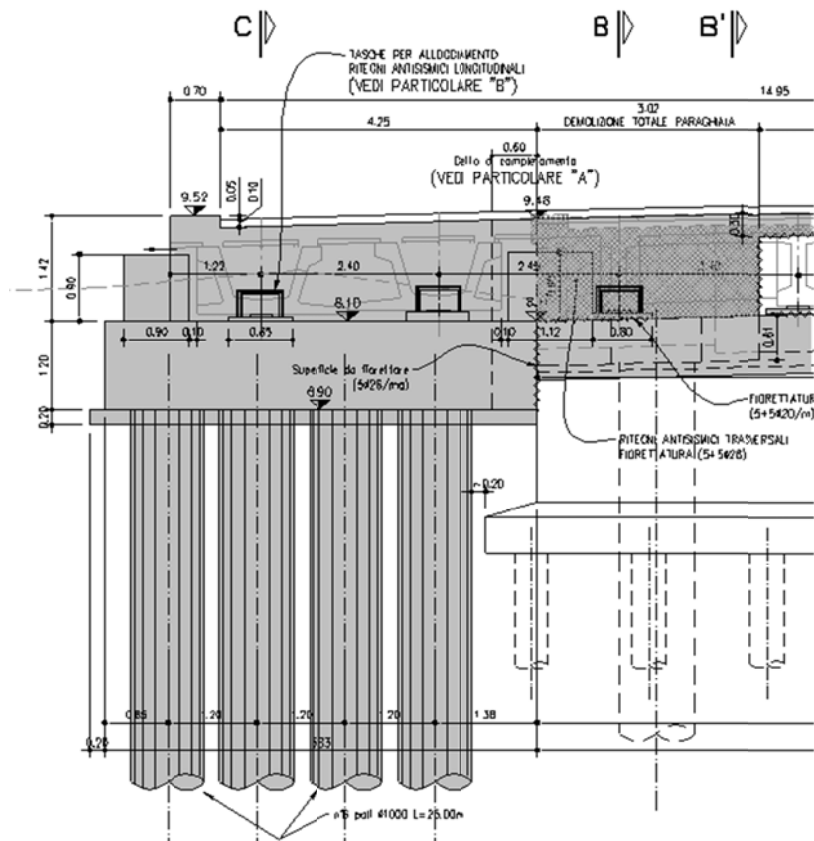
Semi-prospetto spalle con ampliamento
